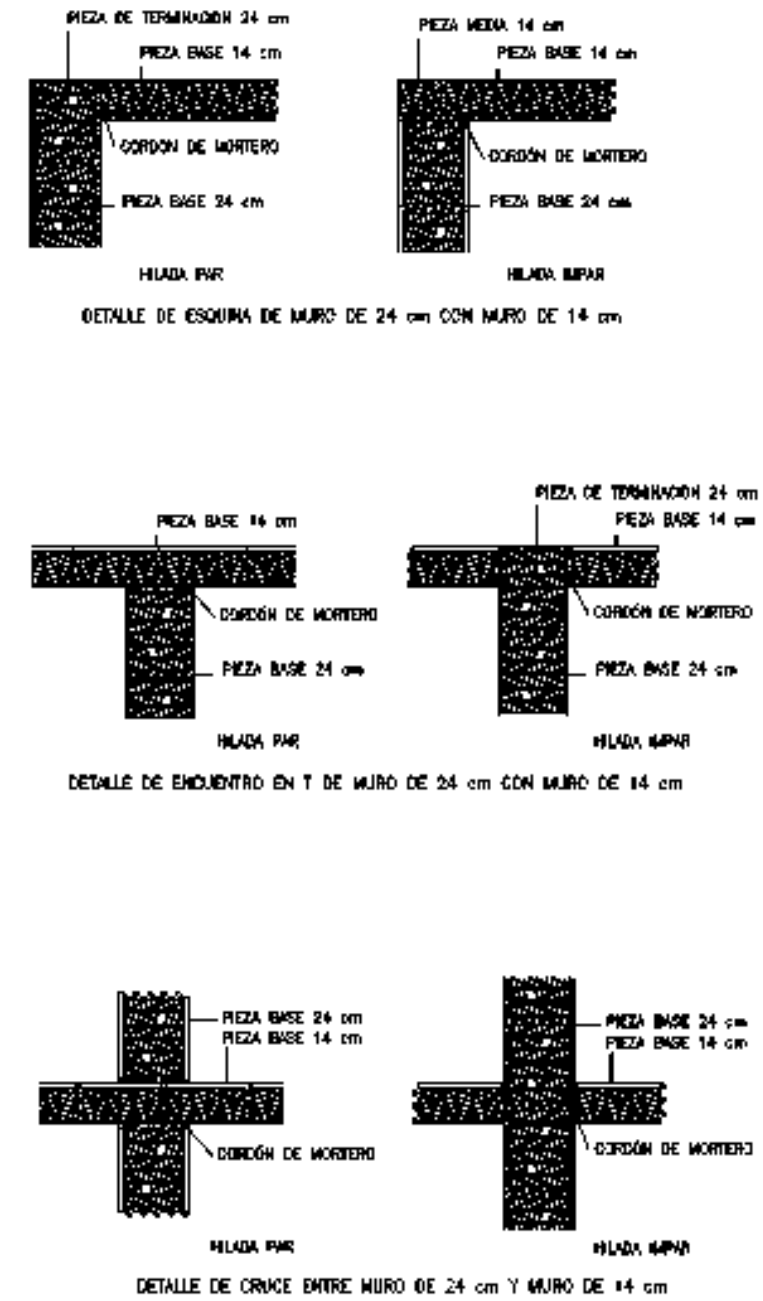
Detalles de encuentro de piezas de 24 cm con piezas de 14 cm.
